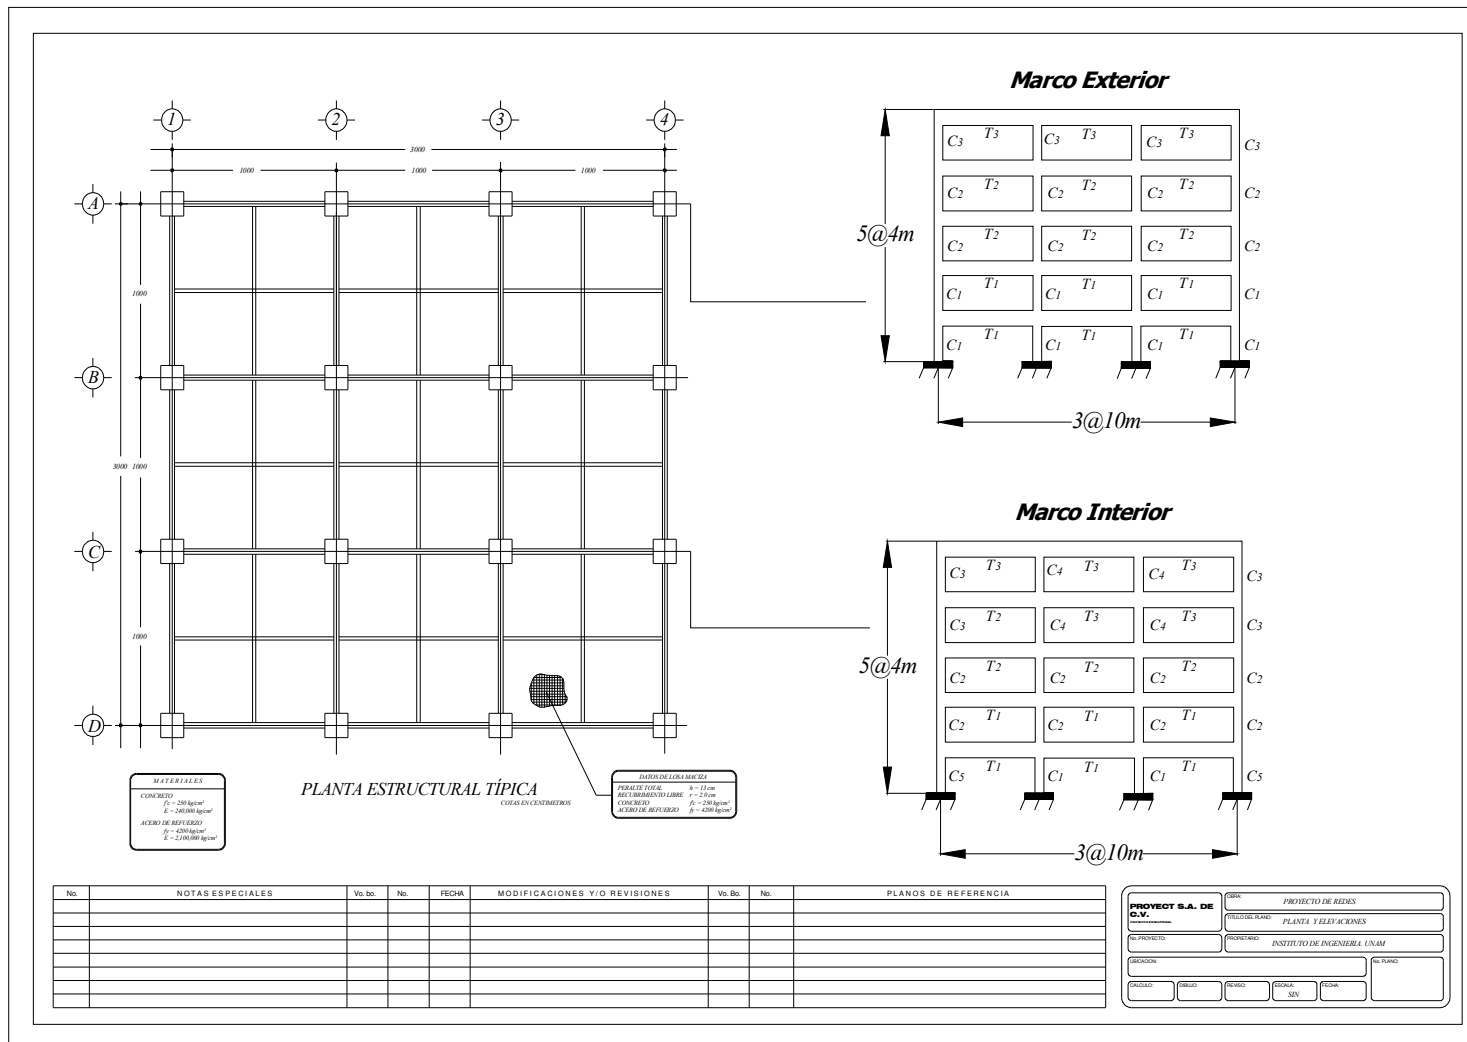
Secciones estructurales del edificio de 5 niveles
